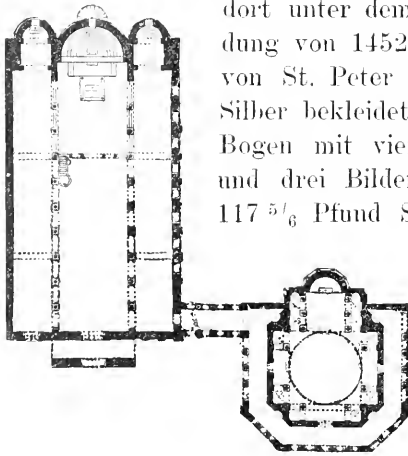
Grundriss der Kathedrale zu Torcello.
